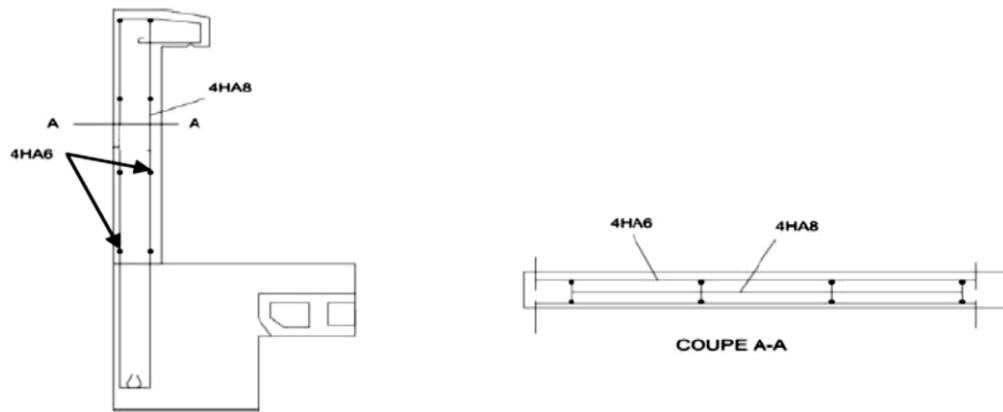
Disposition constructive des armatures de l'acrotère.
